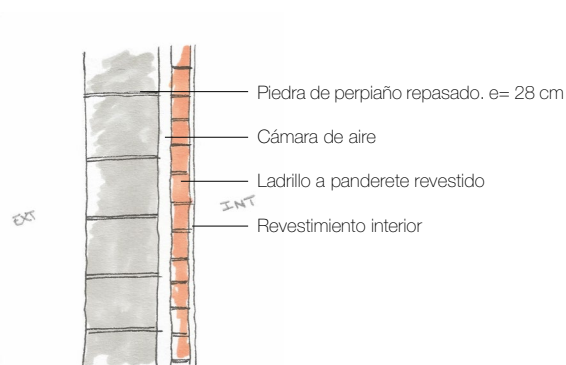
Sección de pared, frontal (Sur) y trasera (Norte) (autoría propia).
